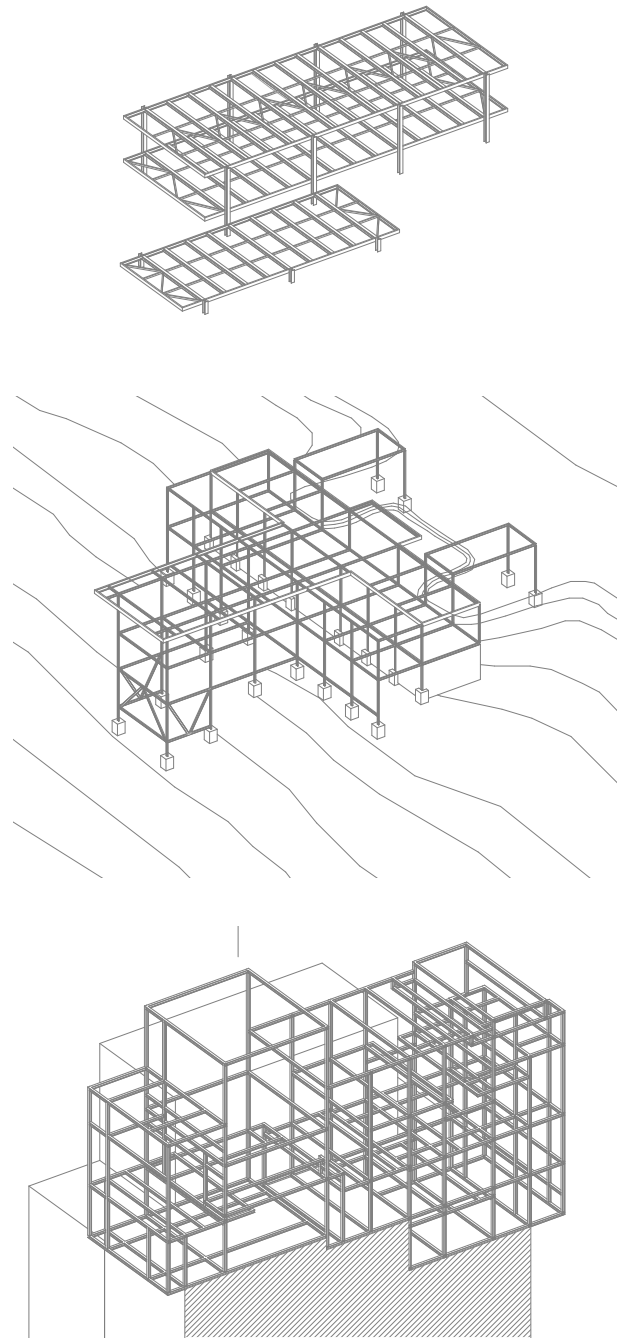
Axonometrie Tragwerk, Vergleich Farnsworth House, Smith House und Rudolph Apartment
